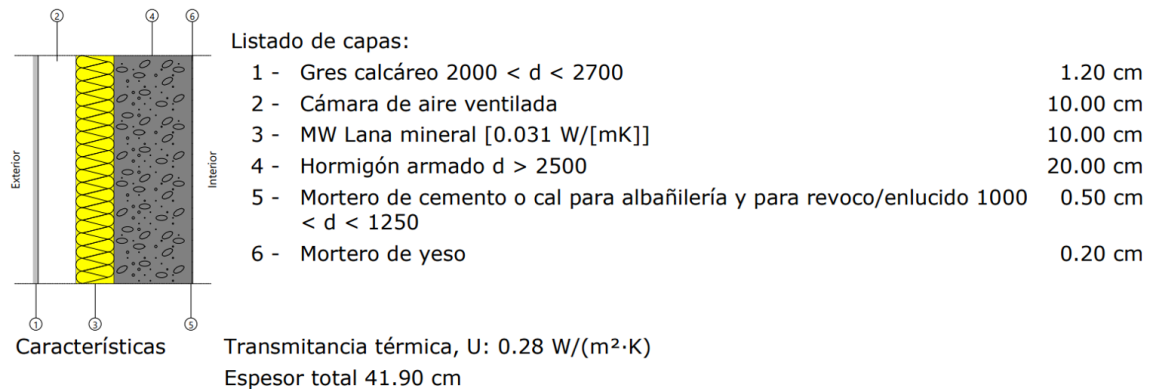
Vista de sección y transmitancia térmica de los muros de concreto fundido de 0.20 metros de espesor de cerramiento con los elementos propuestos de fachada ventilada
